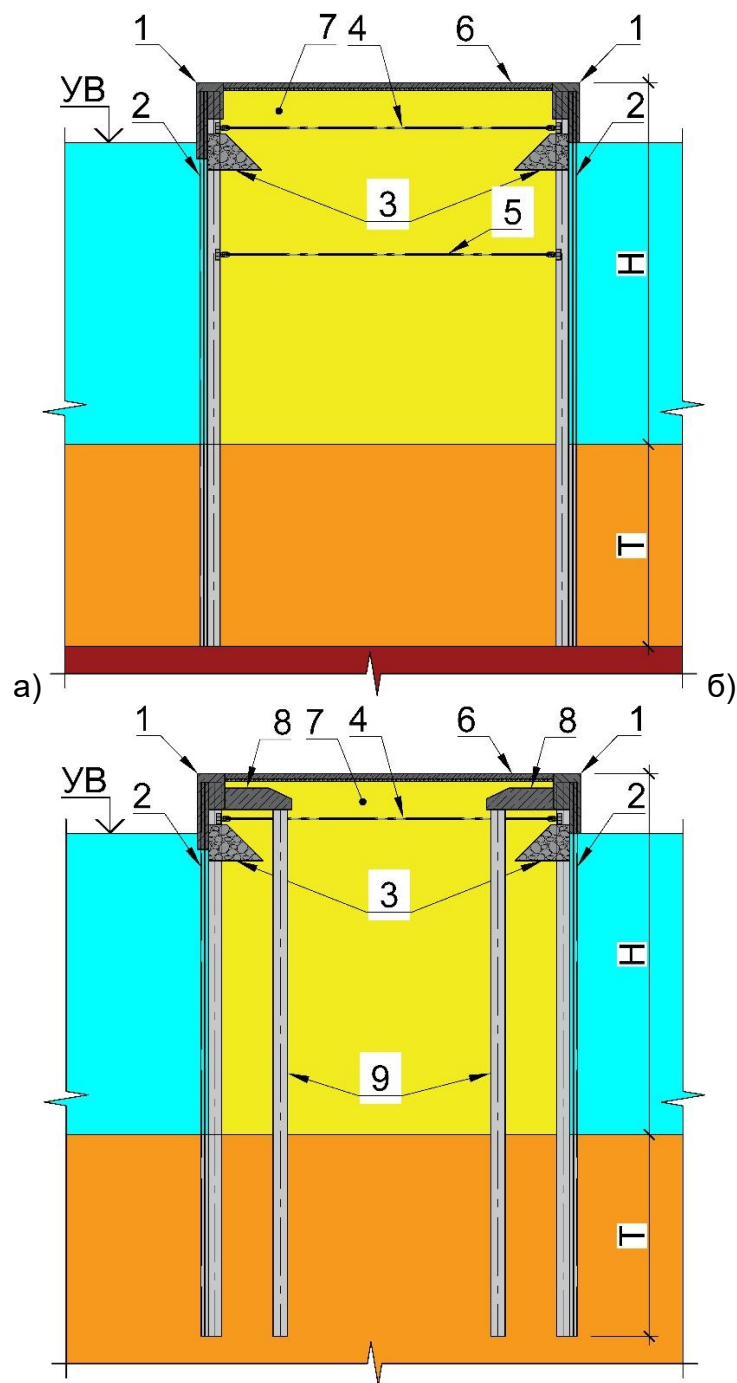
Схемы причальных и ограждающих сооружений ячеистых конструкций и узких засыпных пирсов: Н – высота причальной стенки; Т – глубина погружения шпунта; а – с несколькими ярусами анкеров; б – с экранирующими сваями; 1 – шапочный брус; 2 – БШС; 3 – дренажная призма; 4 – анкерная тяга; 5 – анкерная тяга второго яруса; 6 – покрытие территории; 7 – засыпка; 8 – разгрузочная плита; 9 – экранирующая свая.
